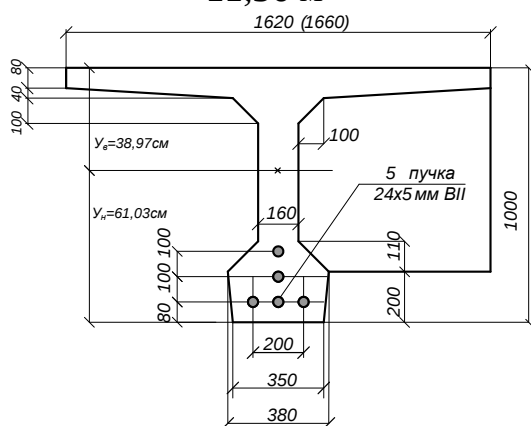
Поперечний переріз крайній балок прогонової будови довжиною 16,76 м
